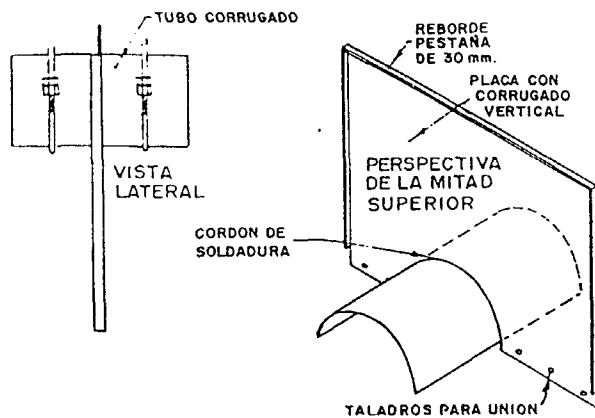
Placas reflectoras en la tubería de desagüe bajo el dique.
